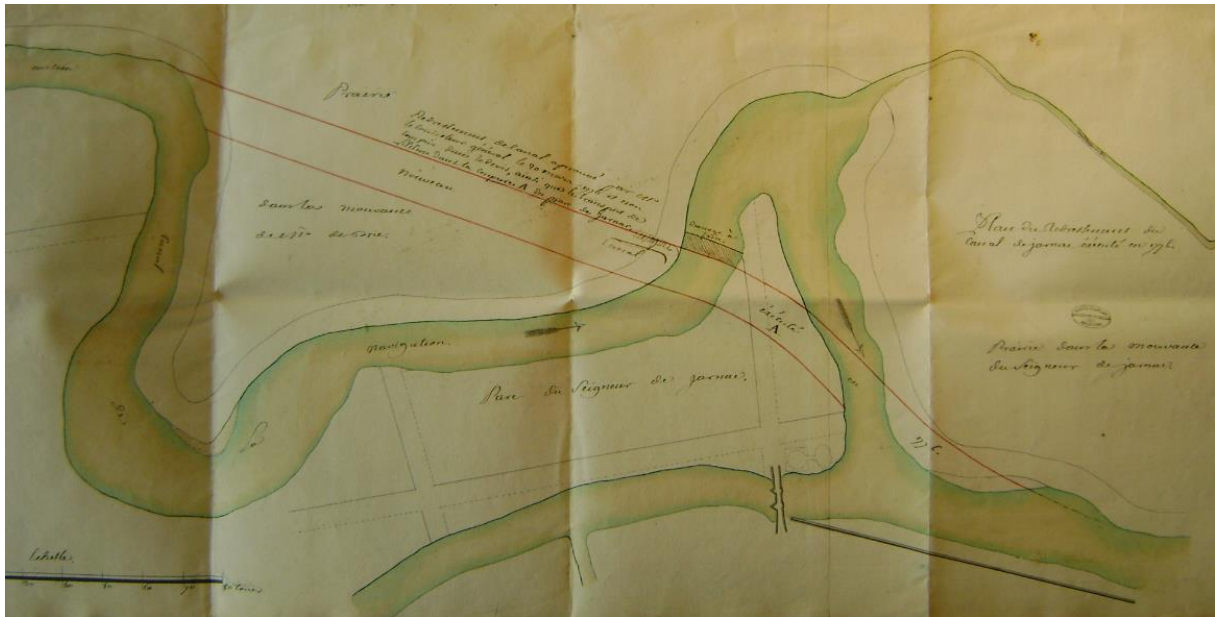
plan de redressement du canal de Jarnac exécuté en 1776, par Trésaguet.
